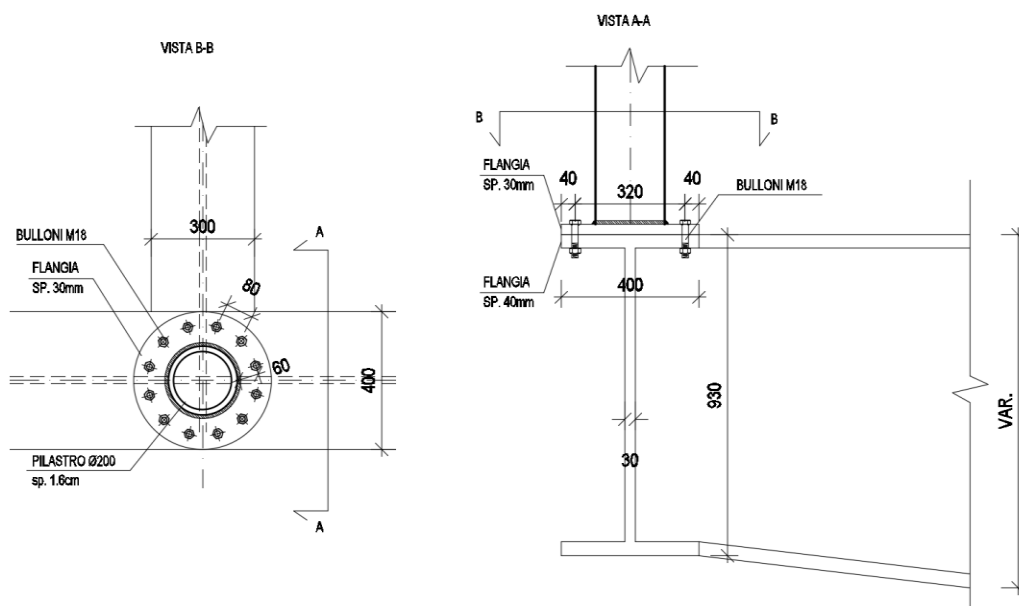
Unione flangiata pilastrini – collegamento con travi inferiori
